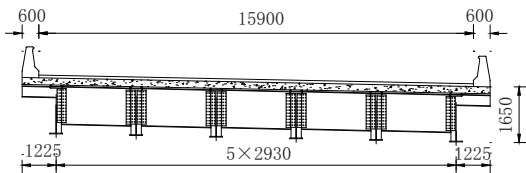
25 m 跨径钢板组合梁标准横断面图(单位:mm)
